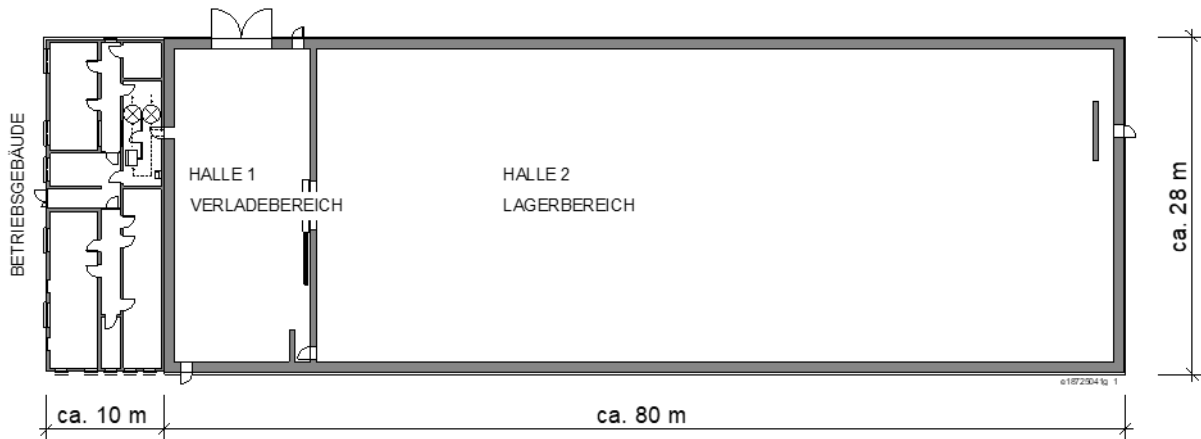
Schematischer Grundriss der TBH-KWG
